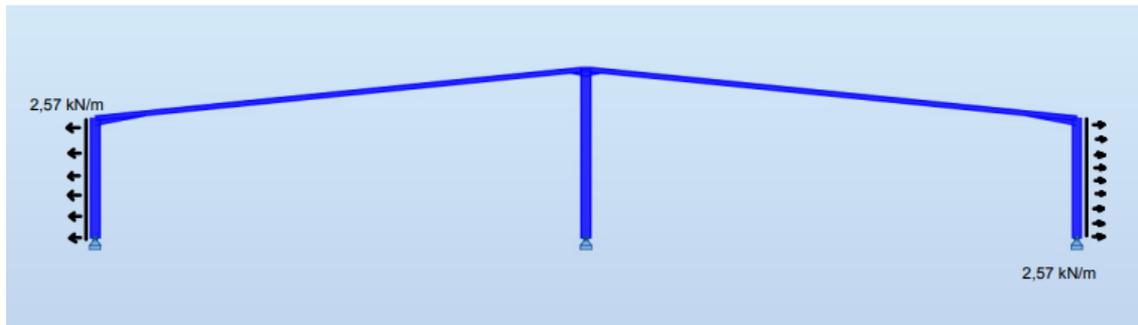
REPRESENTACIÓN CARGAS DE VIENTO EN ZONA C EN PÓRTICO INTERIOR CON DIRECCIÓN LONGITUDINAL A LA FACHADA
